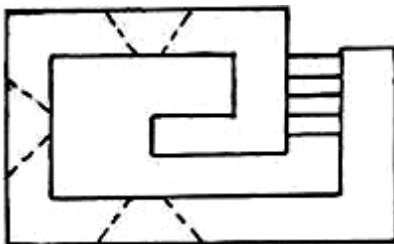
План основного приміщення, командного пункту (КП) (план виду зверху)
